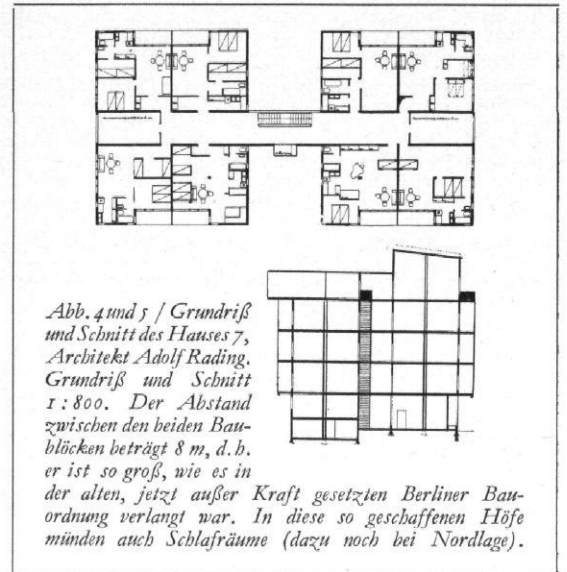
und 5 / Grundriß und Schnitt des Hauses 7, Architekt Adolf Rading. Grundriß und Schnitt 1:800. Der Abstand zwischen den beiden Baublöcken beträgt 8 m, d. h. er ist so groß, wie es in der alten, jetzt außer Kraft gesetzten Berliner Bauordnung verlangt war. In diese so geschaffenen Höfe münden auch Schlafräume (dazu noch bei Nordlage).
